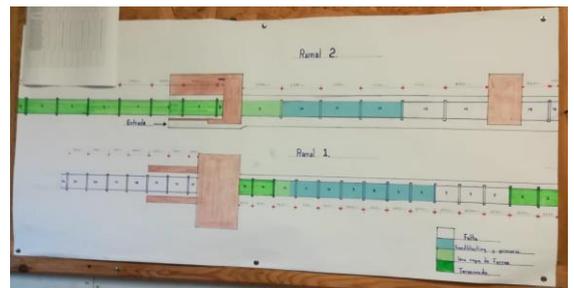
Croquis de la tubería de alta presión que se encuentra en la planta de Río Macho.
